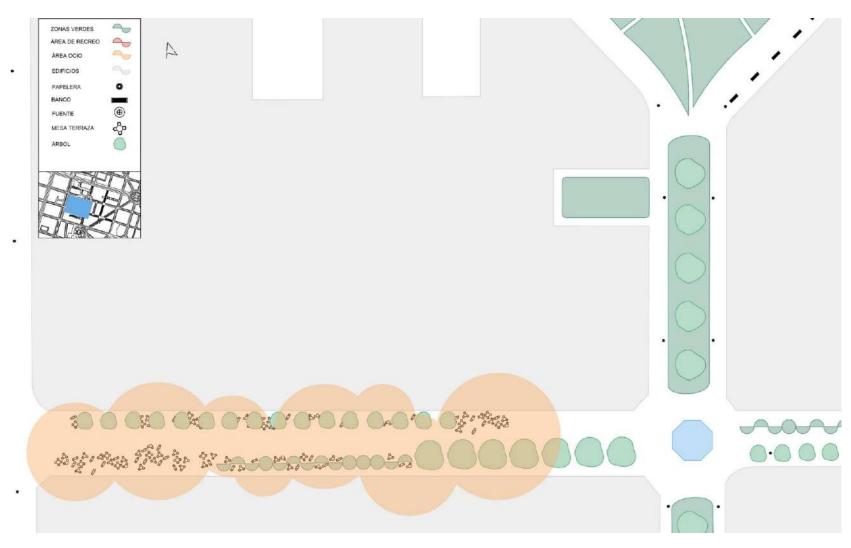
Plano de detalle 3. Escala 1:500 (A3).
